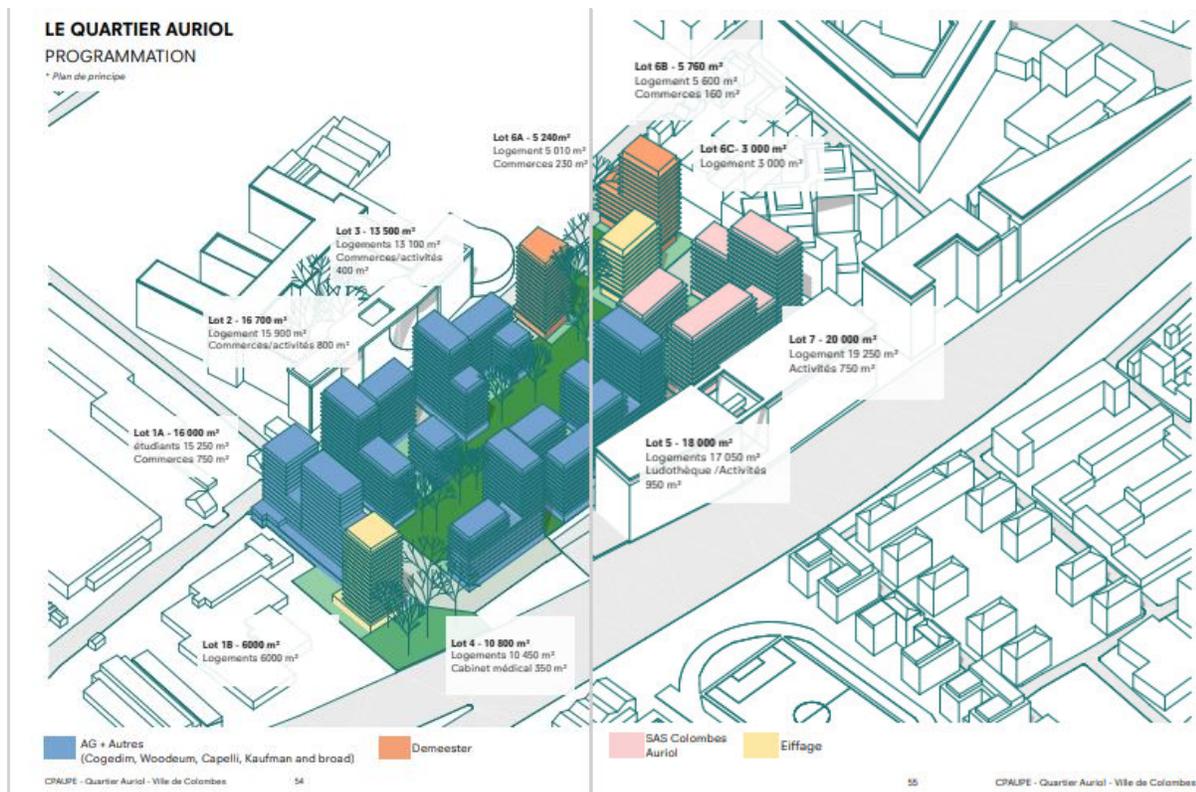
Épannelage des immeubles à construire sur le terrain d'assiette.
